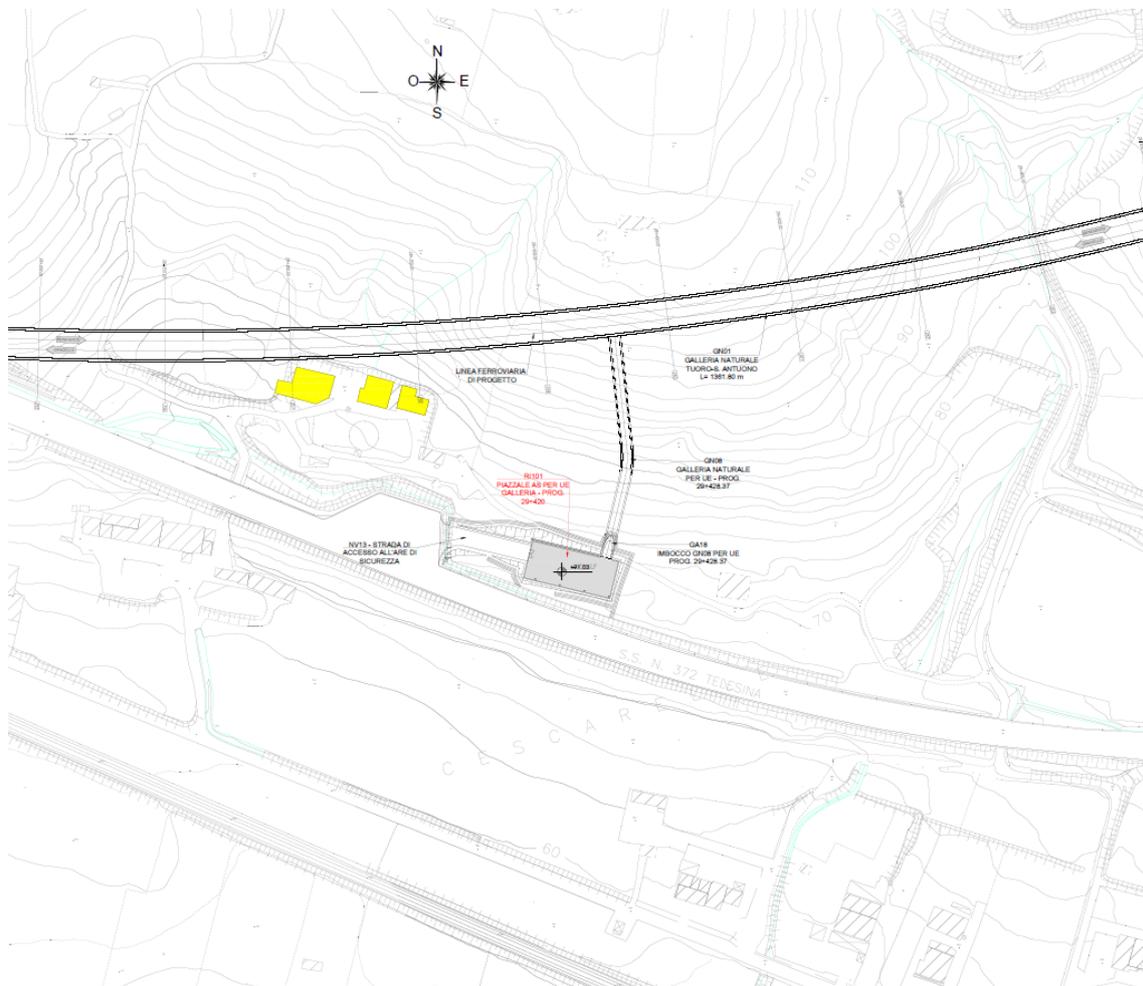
Planimetria generale_RI101 – pk. 29+420
